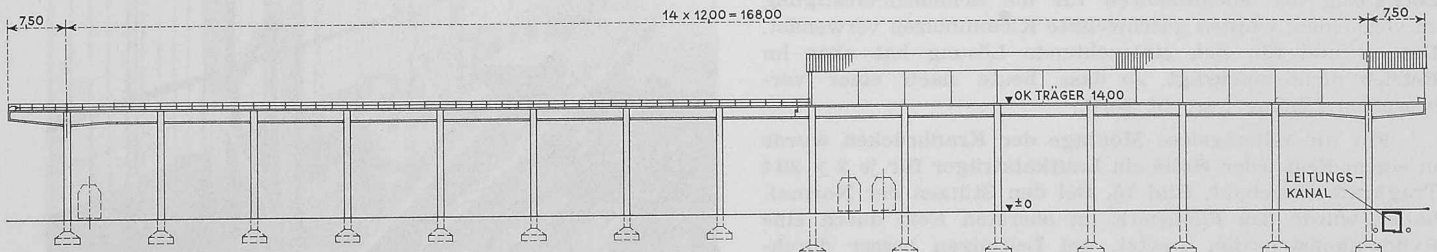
Disposition einer Hofkranbahn, 1:1000
